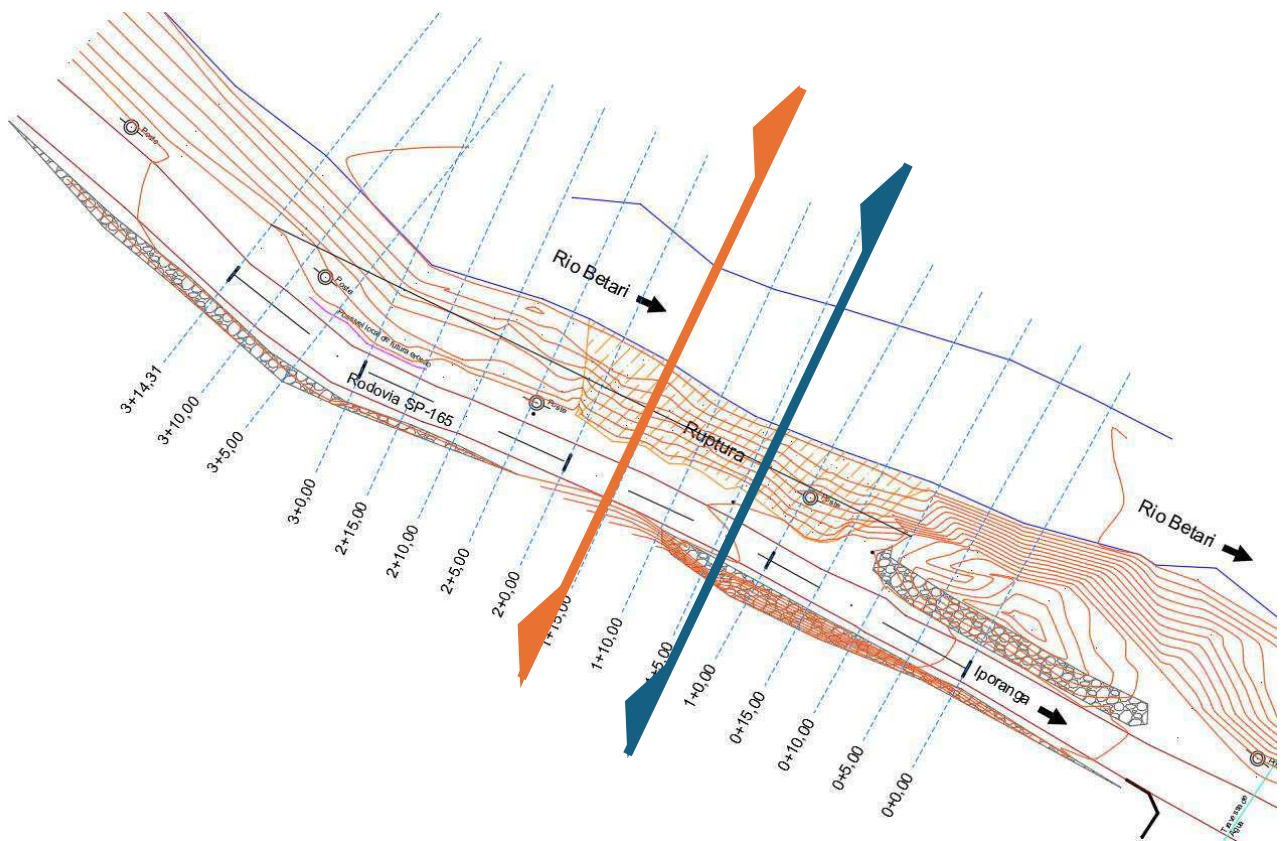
Desenho em Planta da localização das Seções estudadas– Seção Retroanálise em laranja (1+15,00) e seção de projeto em azul (1+5,00).
